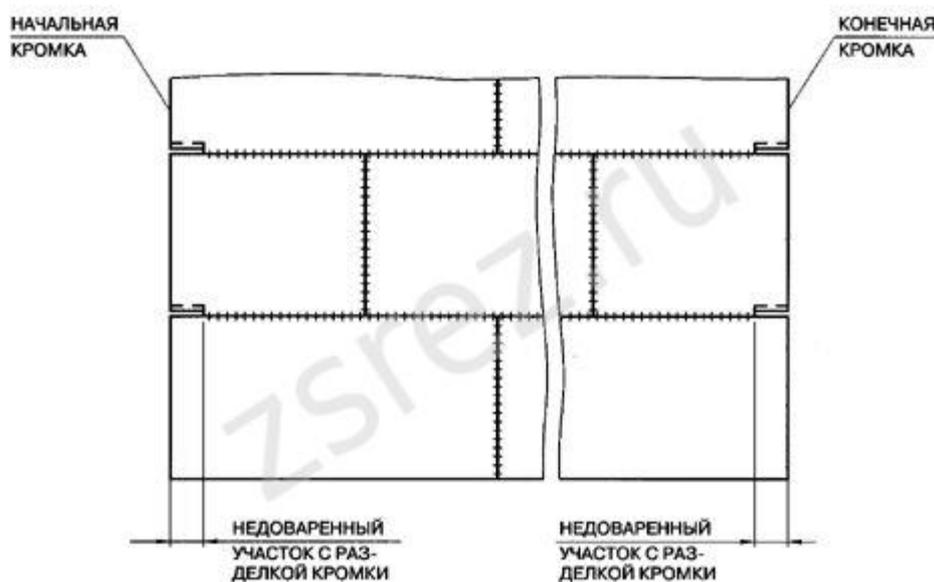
Схема сборки и сварки полистовым методом
